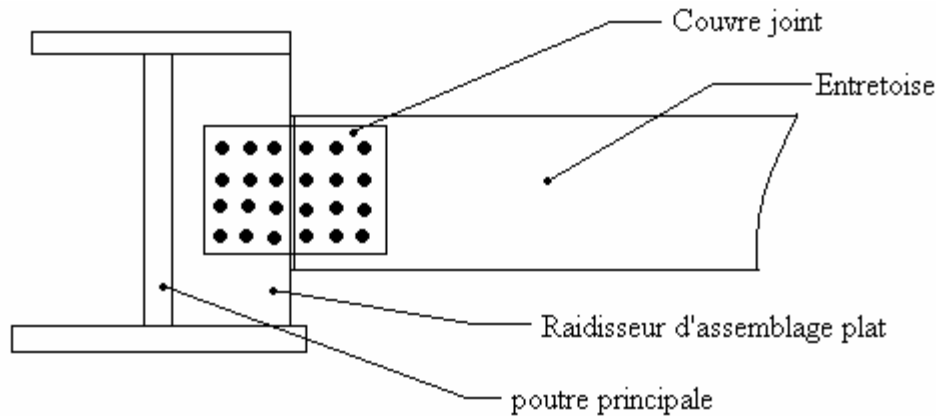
Vue transversal d'assemblage poutre principale – entretoise
